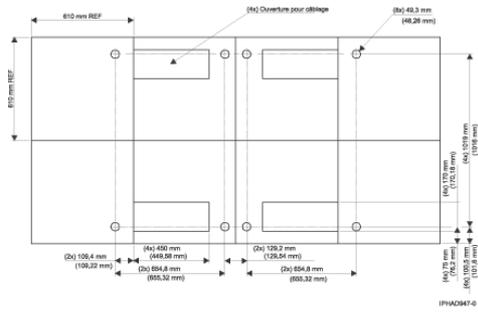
Positionnement des boulons à oeil pour dalles de plancher de 600 mm
